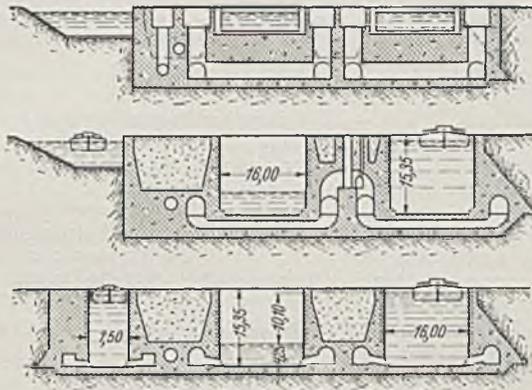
Querschnitt durch das Oberhaupt mit den Zylinderschützen.
